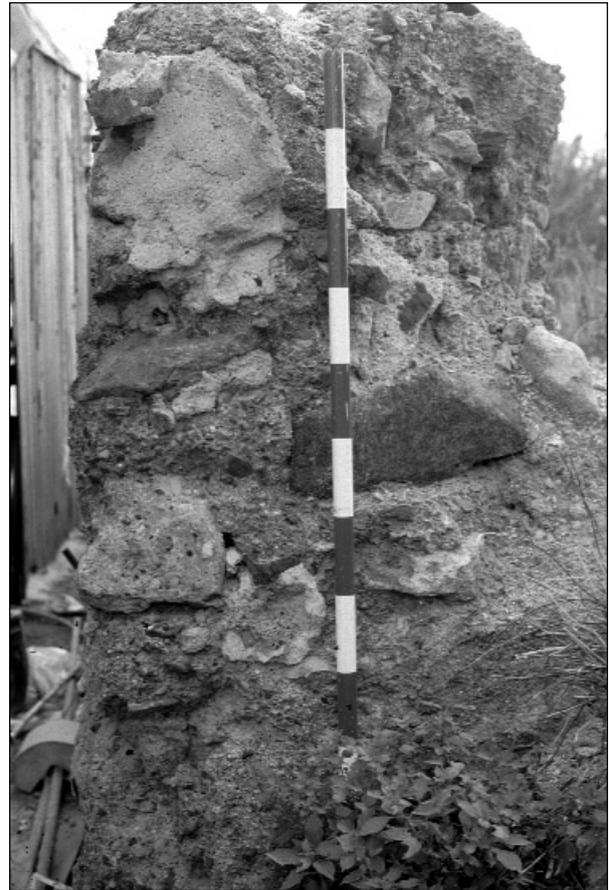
Torre del Batán. Muro perimetral. Lienzo oriental. Detalle: sección de la
